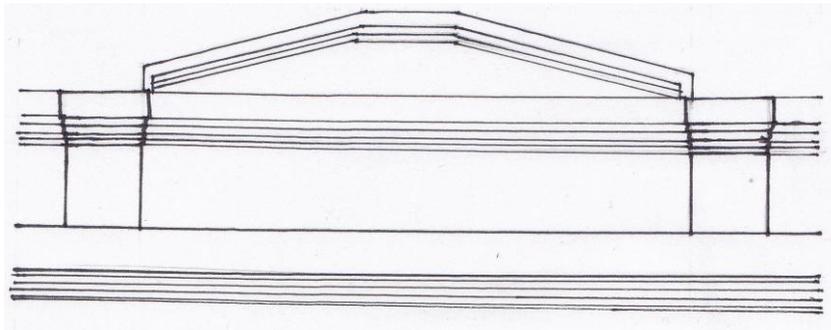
Decoración en esquina remate de fachada. Elaboró: Mauricio Sosa
